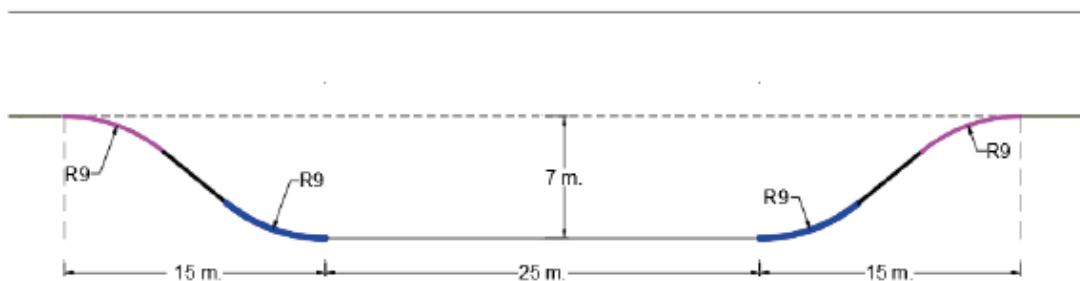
Detalle de la plazoleta de giro - Vía perimetral.
